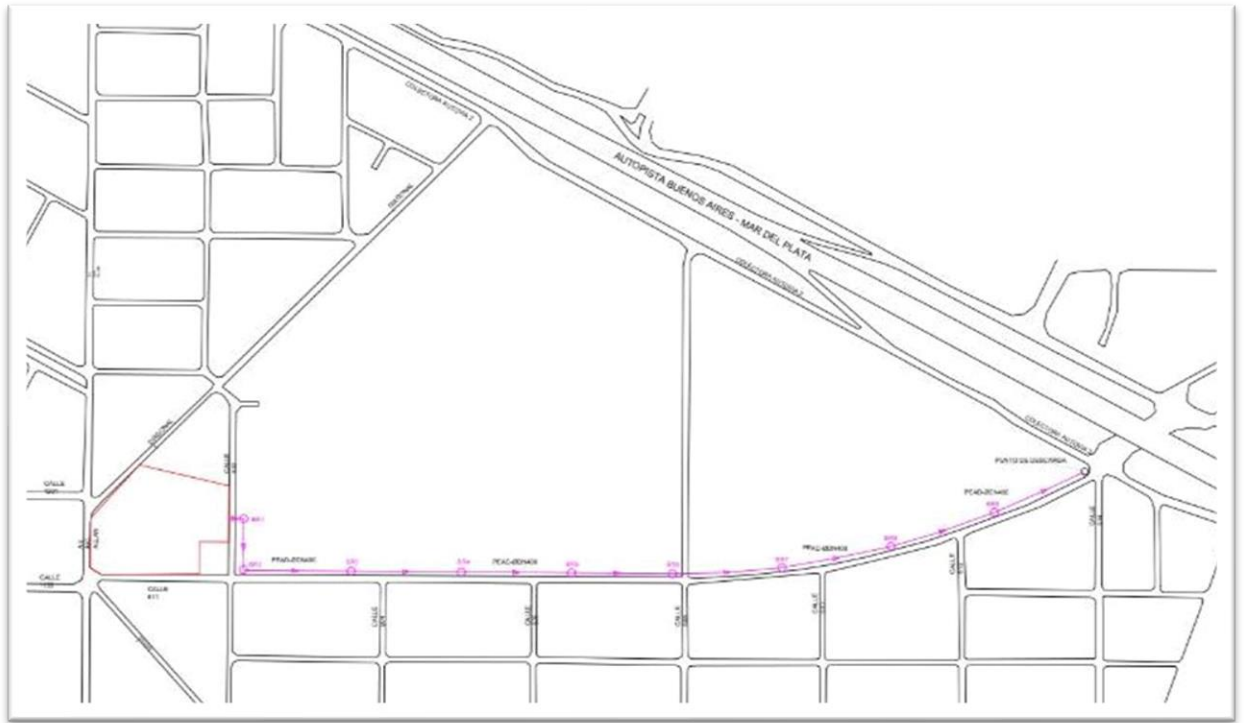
Vista en planta del conducto derivador del efluente tratado. Fuente OPISU.
